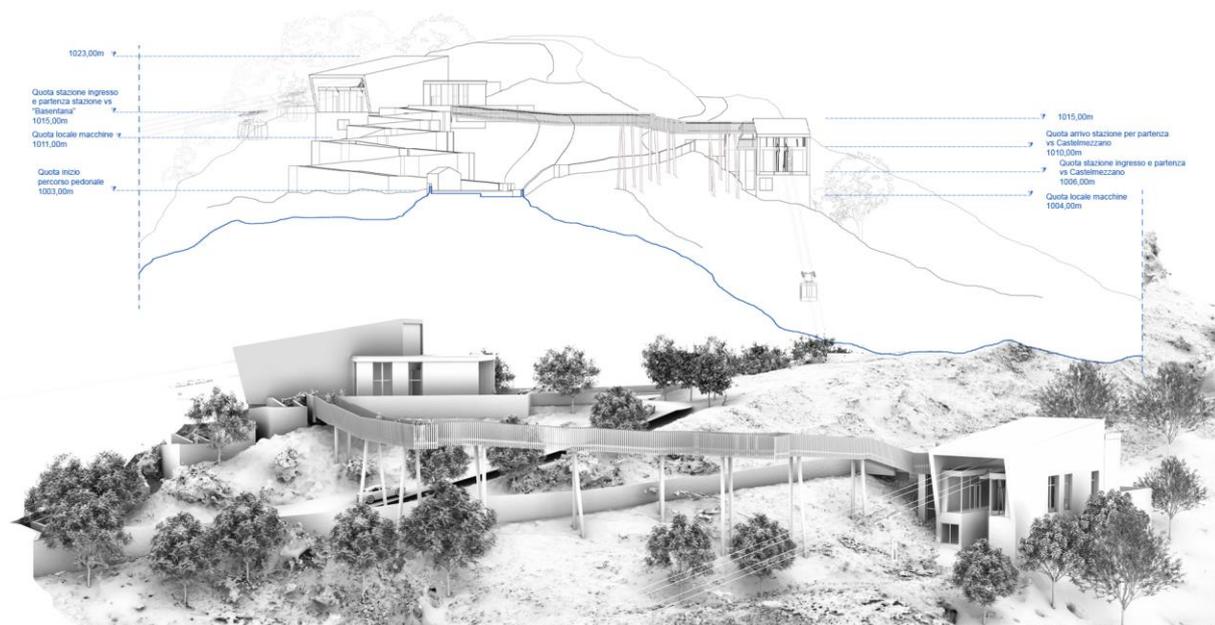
Sezione dell'HUB 2 e vista prospettica (elaborazione grafica) della soluzione a.
